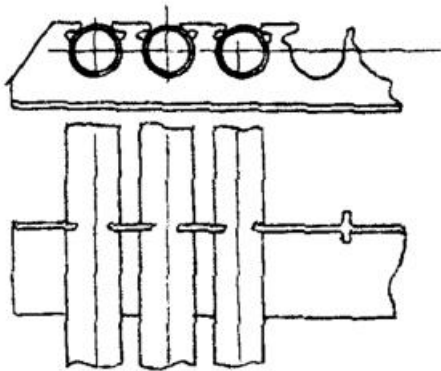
Схема крепления полиэтиленовых труб для электропроводок в уголках из листовой стали с вырезами
